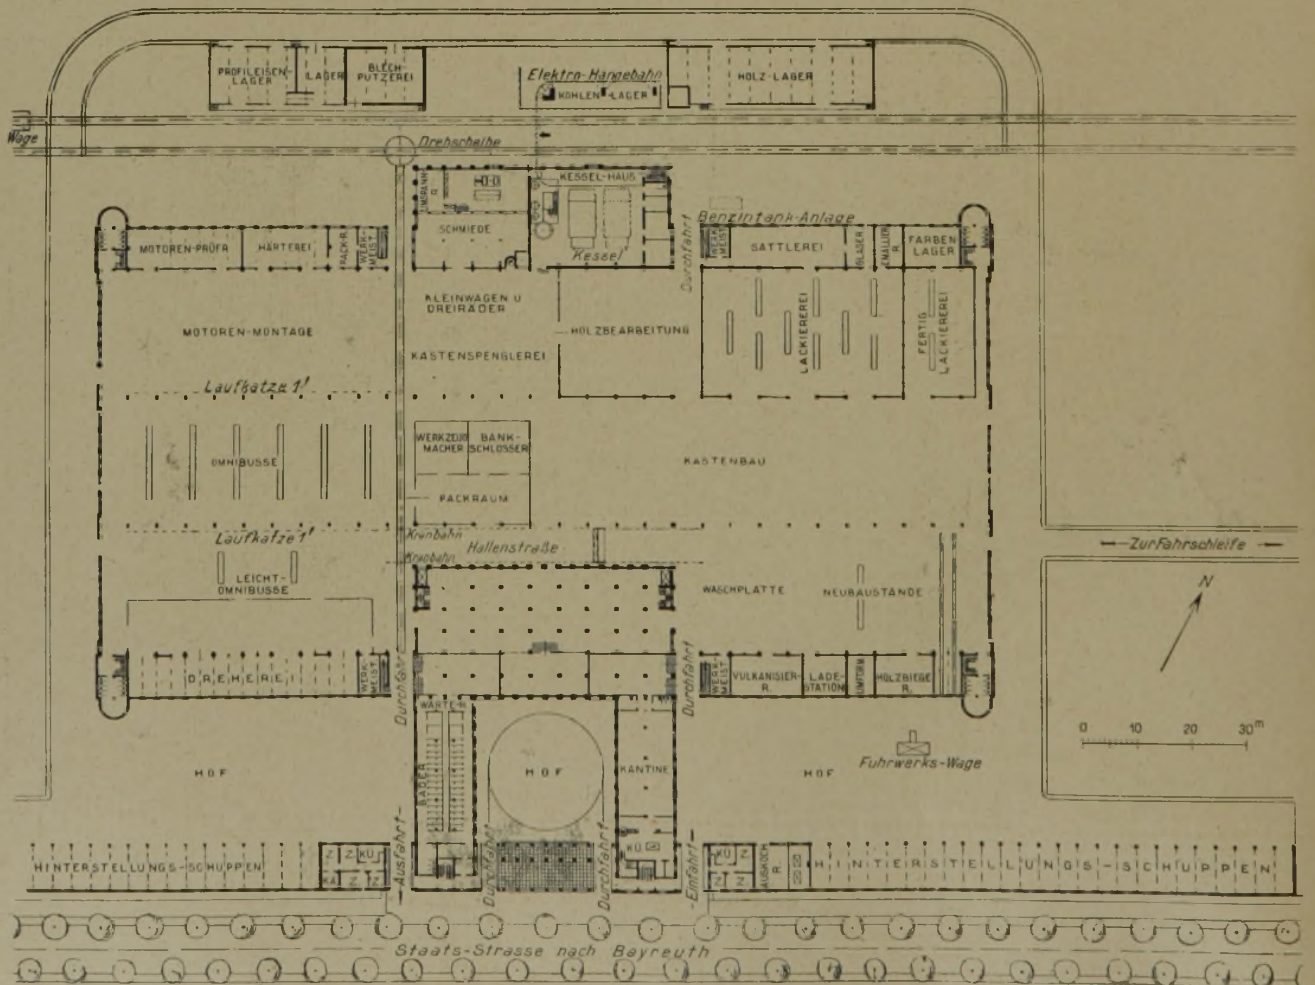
Grundriß des Erdgeschosses. (1 : 1400.)
